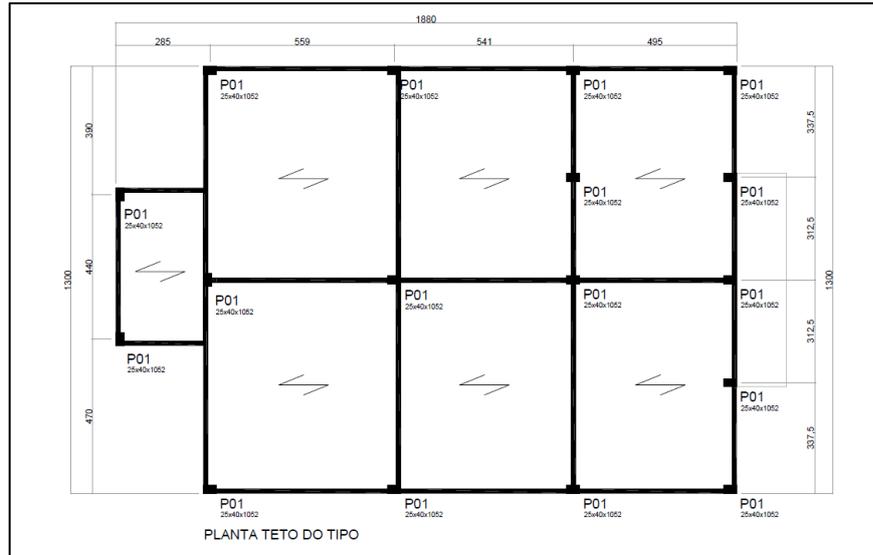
Projeto estrutural 02: Nível +7,10 m
